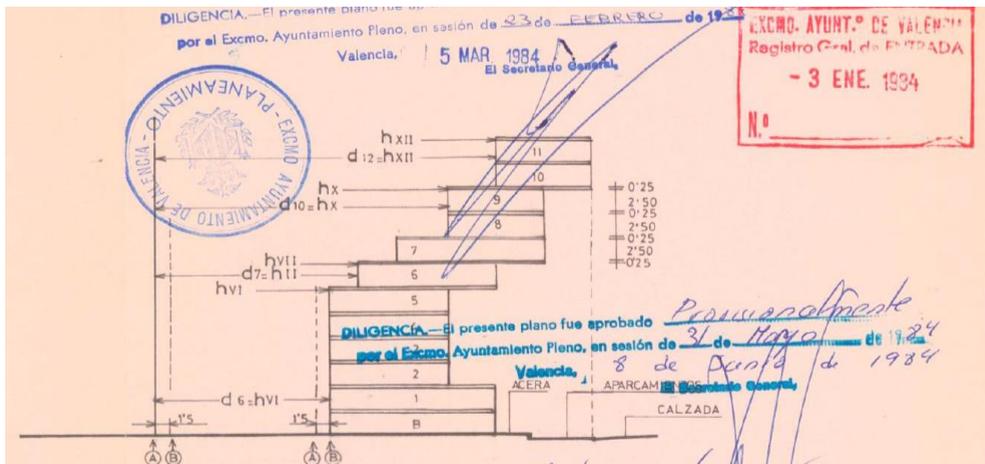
Sección esquemática en Plano de volúmenes y número de viviendas del P.E.R.I. Espai Verd. Fuente Archivo urbanístico del Ayuntamiento de Valencia.
